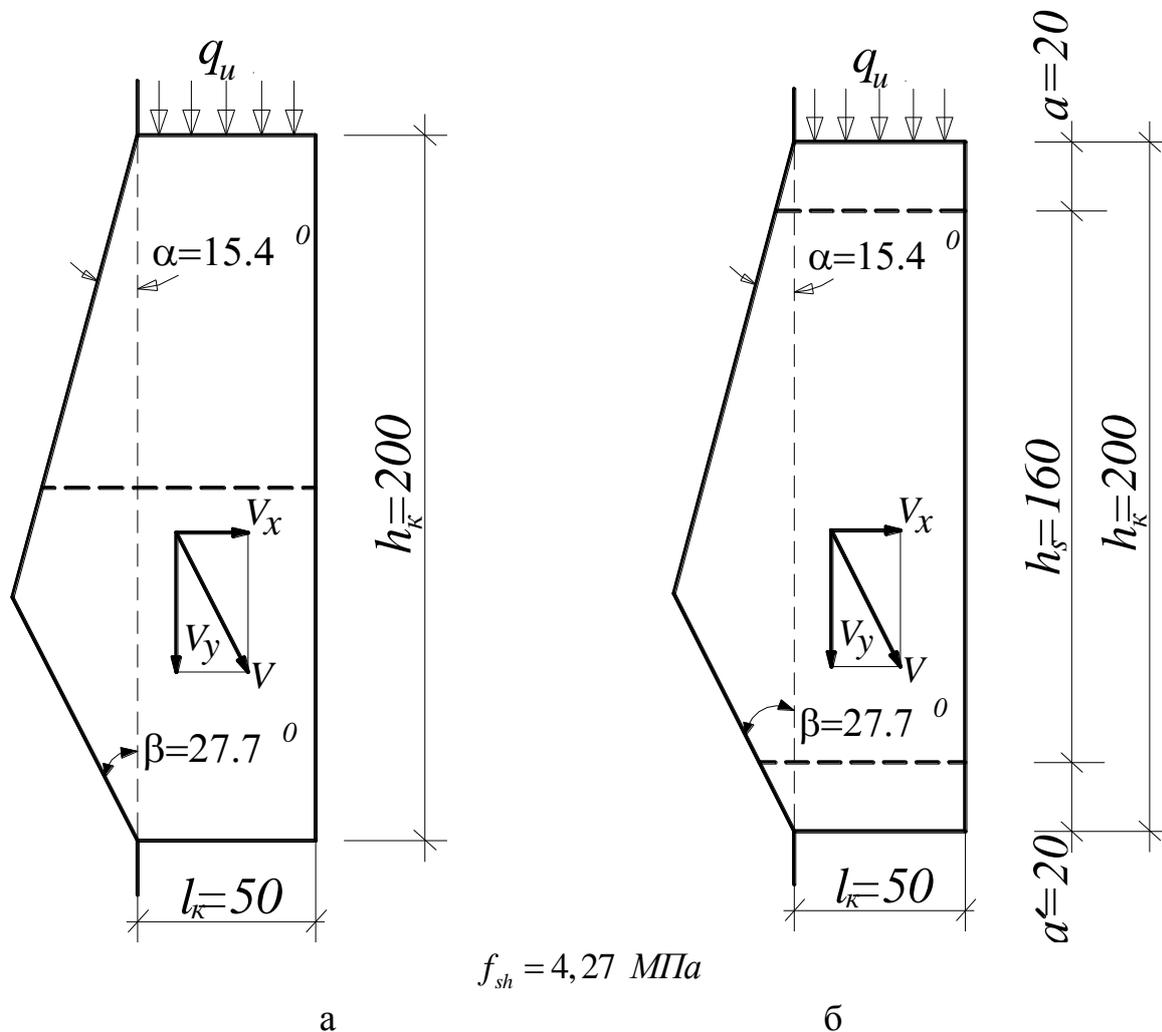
Параметри кінематичної схеми руйнування залізобетонної прямокутної шпонки: а – із розміщенням арматури в один ярус посередині її висоти; б – при двоярусному армуванні
